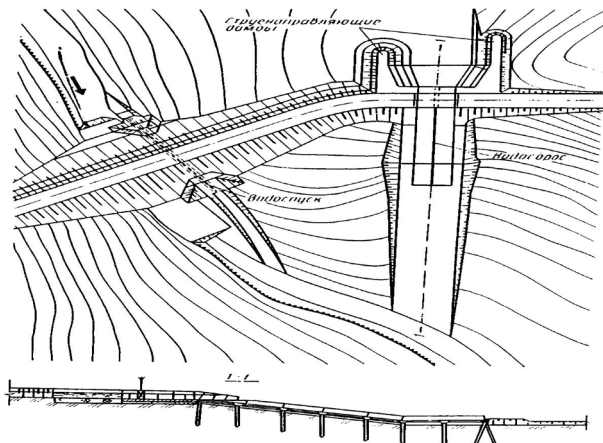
Гидроузел с грунтовой плотиной, береговым открытым управляемым водосбором и водоспуском на одном берегу
